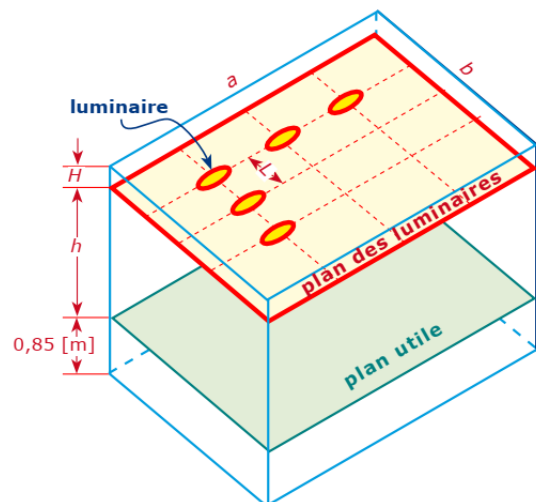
Hauteur entre le plan de travail et les luminaires en suspensions
